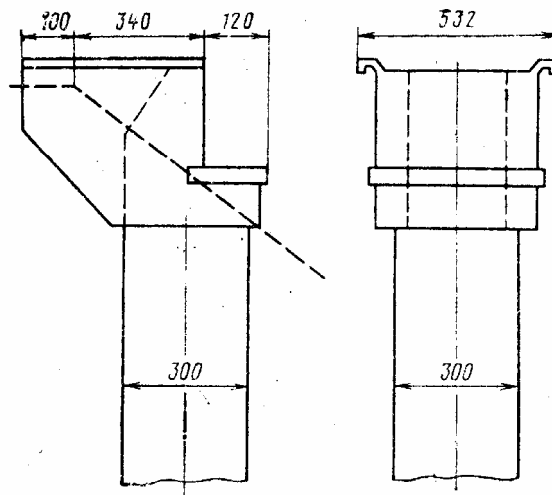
Устой из центрифугированной железобетонной оболочки большого диаметра
